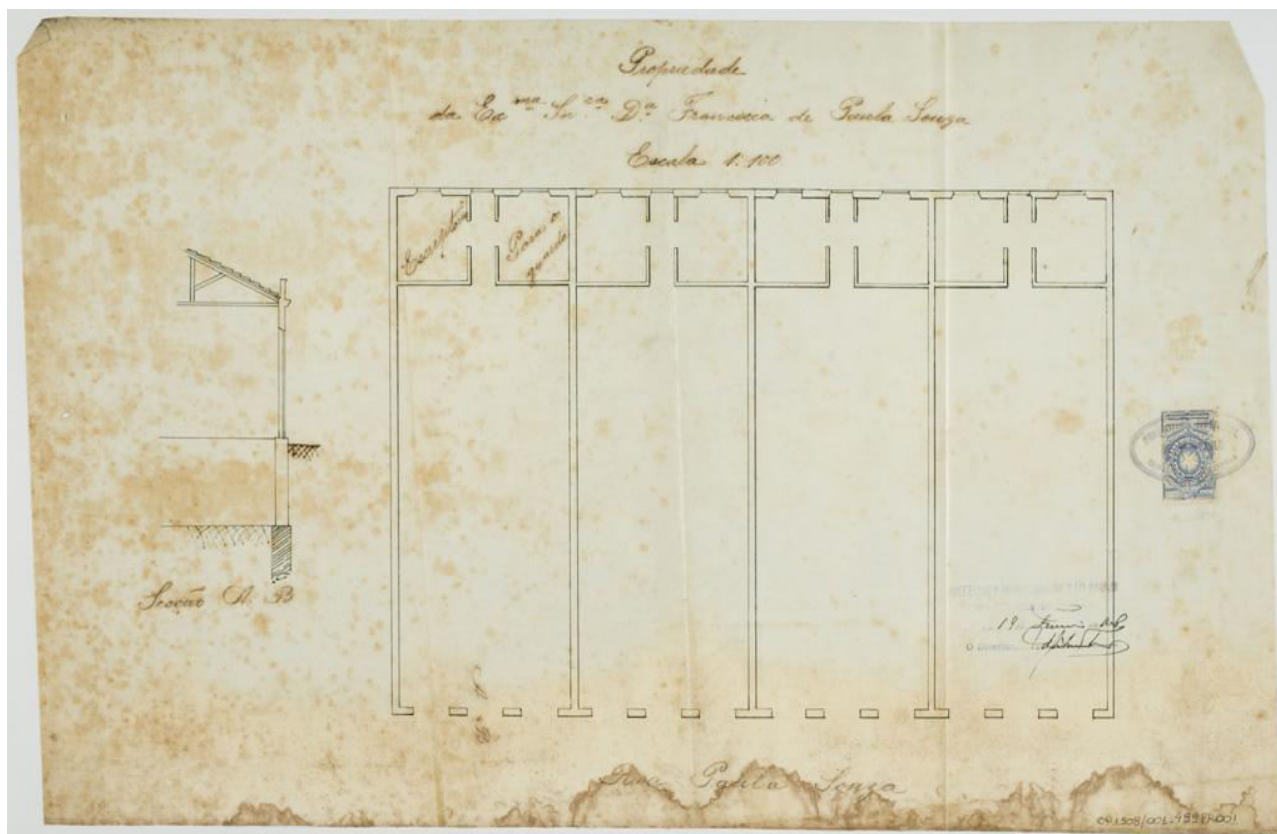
Projeto para construção de 4 armazéns na rua Paula Souza. Ano: 1908. Bairro: Sé.
